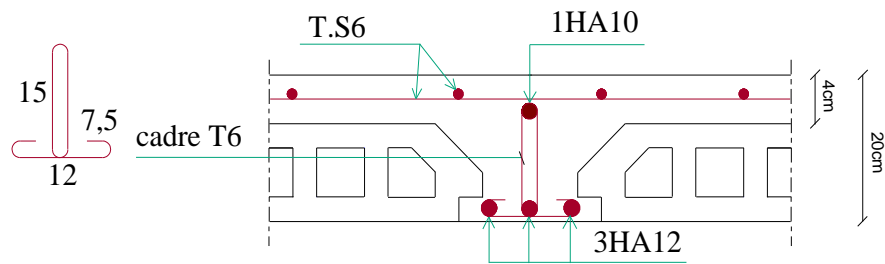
Schéma de ferrailage des poutrelles en travée.
